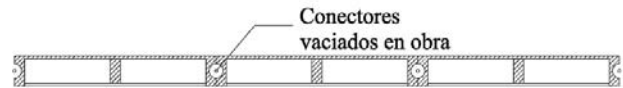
Conexión entre placas de paredes continuas primera alternativa.
